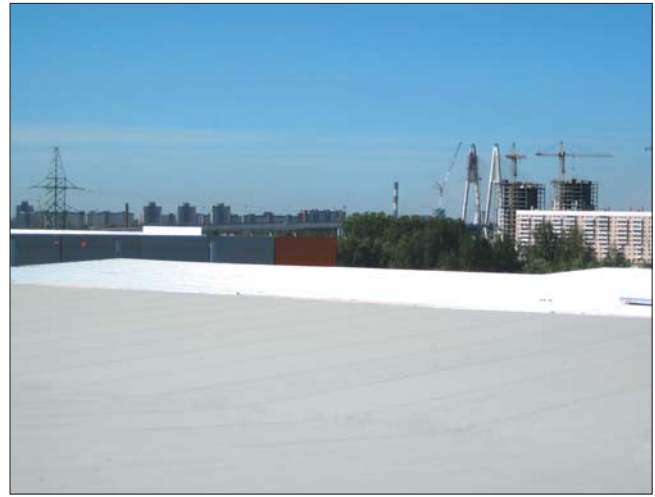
Мембрана ПЛАСТФОИЛ® (PF) – надежная кровля промышленных и жилых зданий
